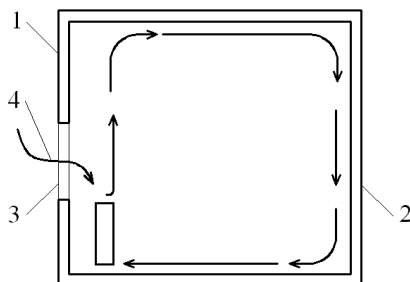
Примерная схема движения воздушных потоков в помещении при расположении отопительного прибора у наружной стены под окном: 1 – наружная стена помещения; 2 – внутренняя стена помещения; 3 – окно; 4 – поступление наружного воздуха в помещение
